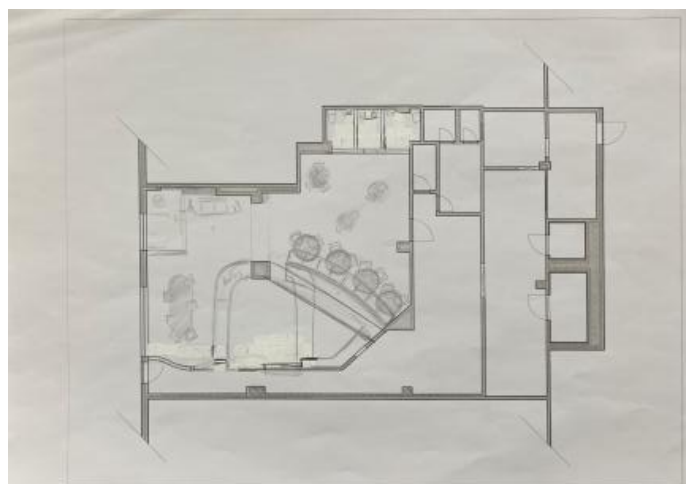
Planta de estudo 8. Fonte: Autora, 2025
